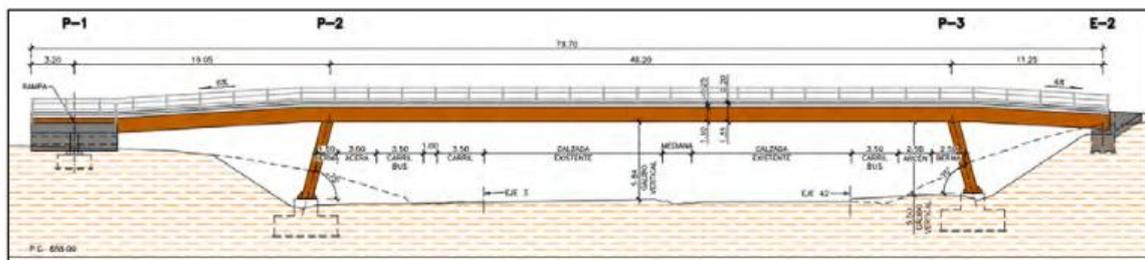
Alzado longitudinal de tramo de cruce PAS 9+470
